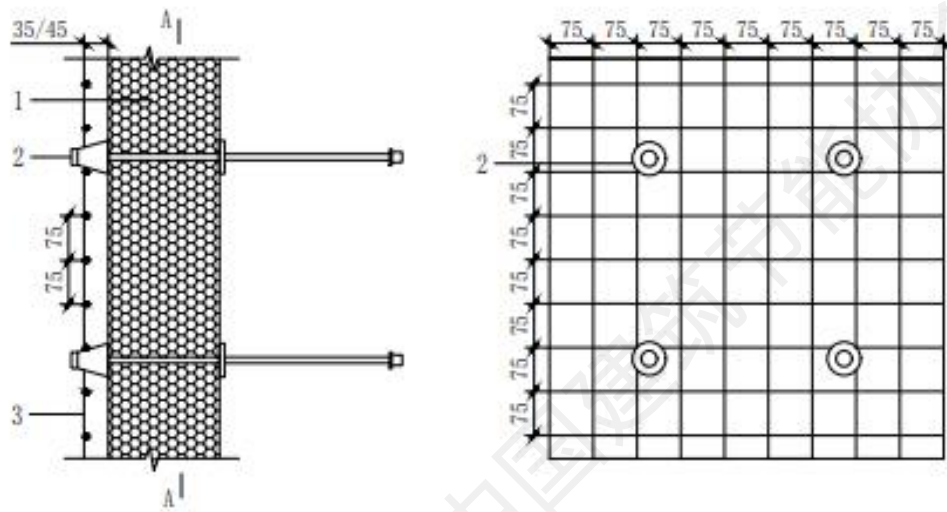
砵芯单面钢丝网片保温板基本构造示意
